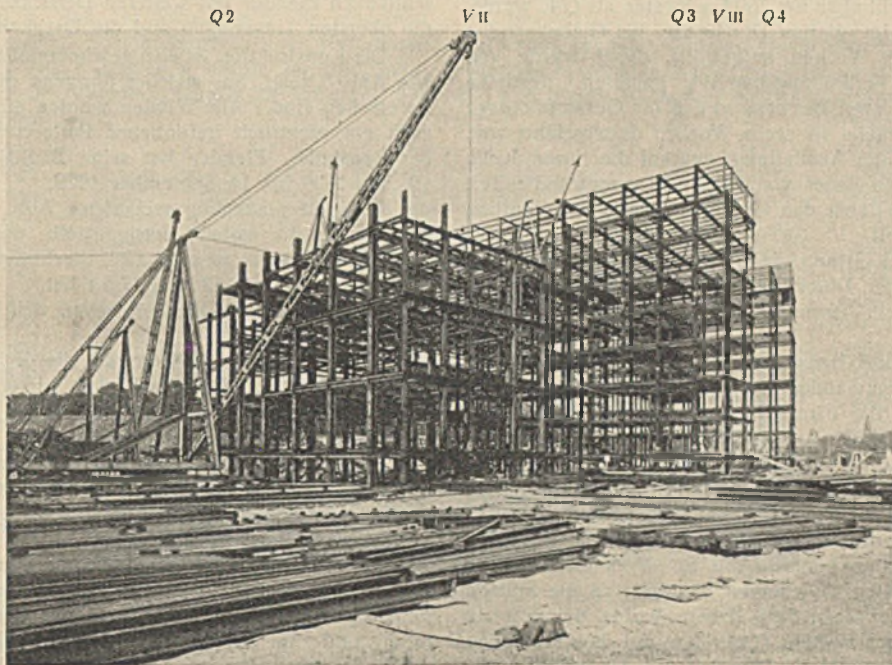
Stufenweise Montage mit Auslegerkranen.
